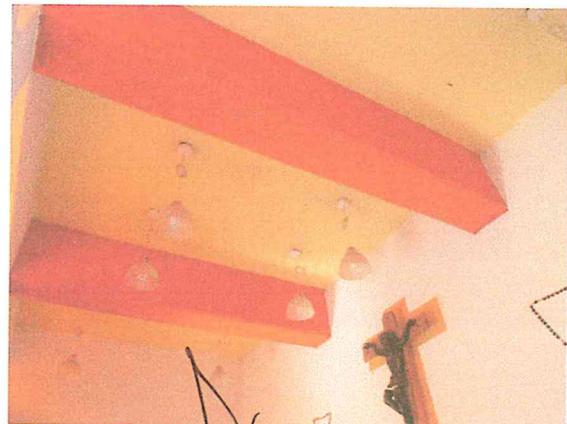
Losa y travesaños de la zona de la capilla, sin afectaciones estructurales.
